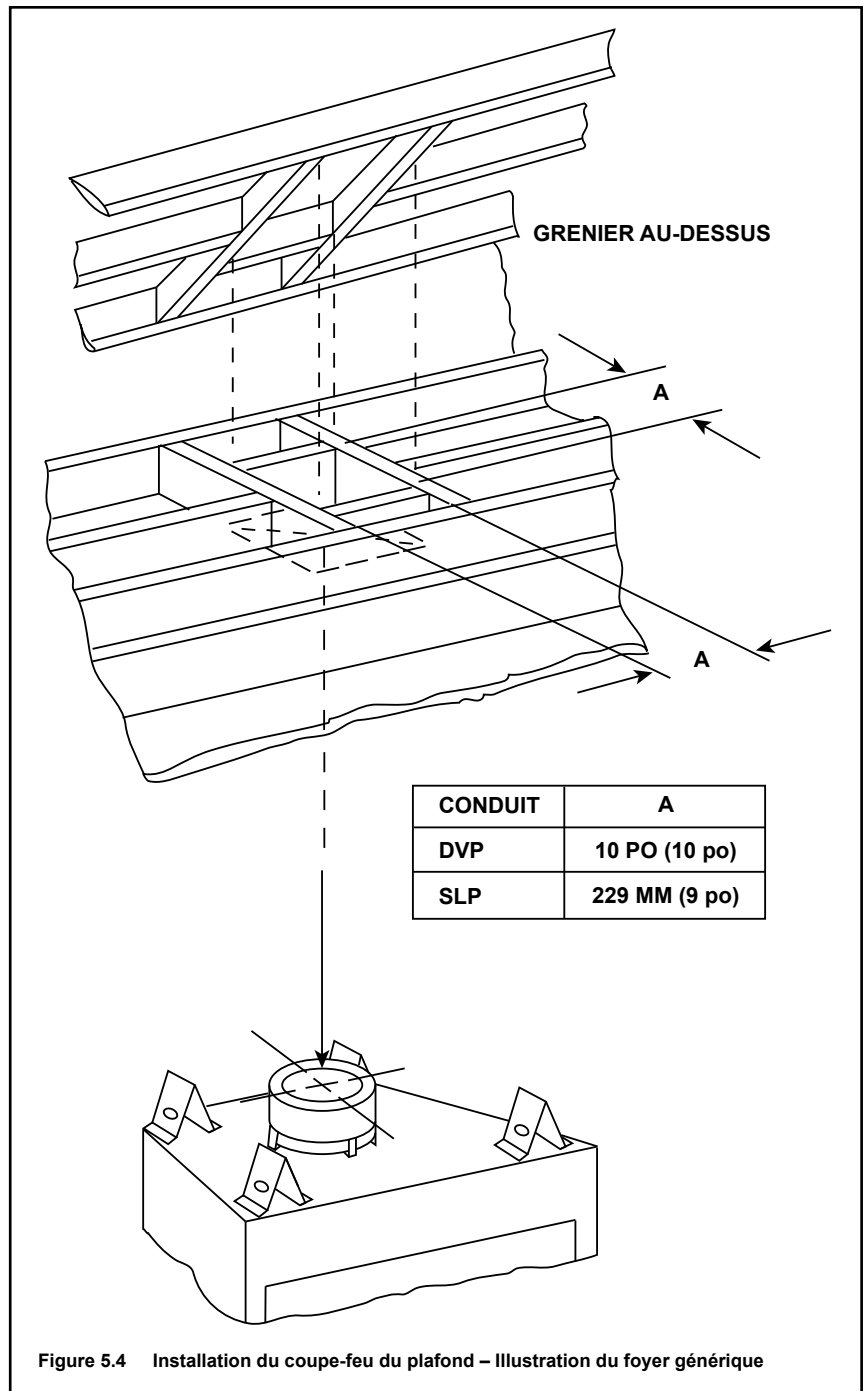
Installation du coupe-feu du plafond – Illustration du foyer générique
